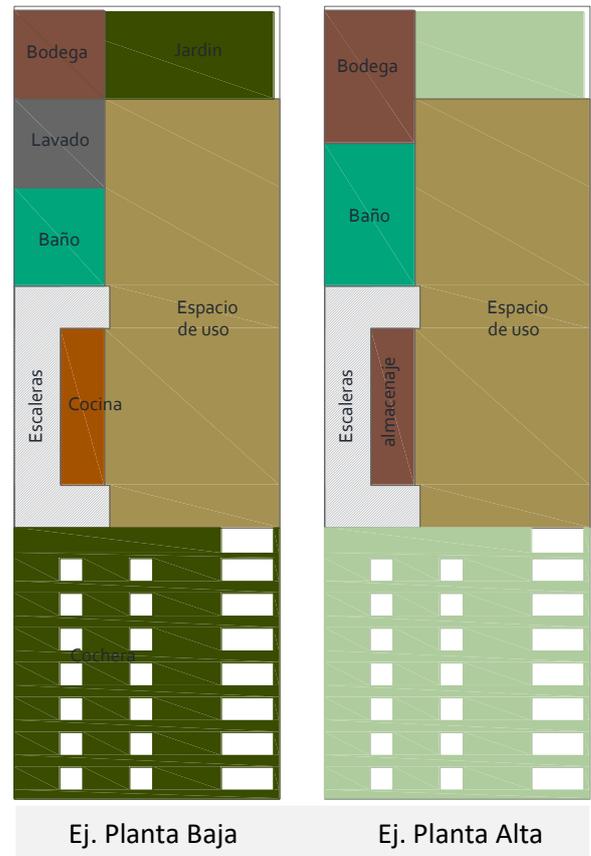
Alcántar. A. 2009. Vista Planta. Plano. Elaboración Propia
